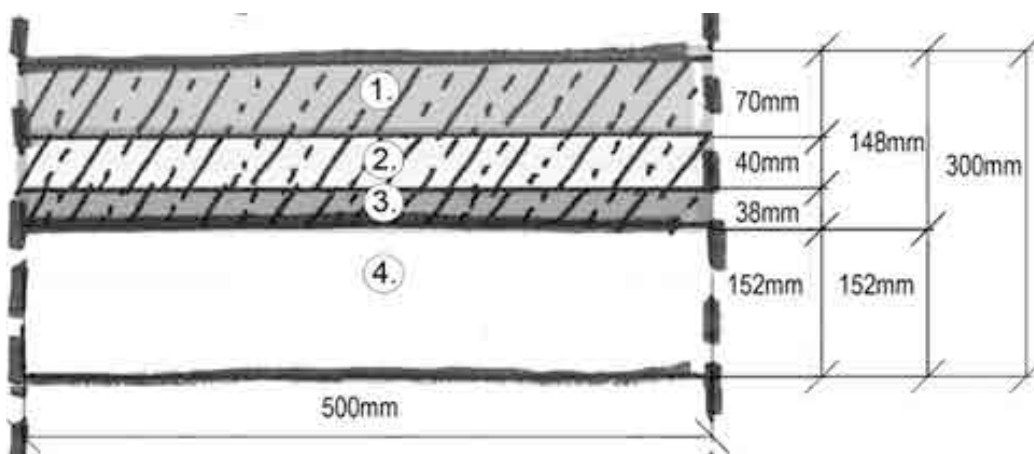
Durchschnittliche Betonmenge, = 148mm Beton Bestand, die kann als Vorlage gestellt werden, Hohlraumdecke Bestand\_30cm\_7cm
